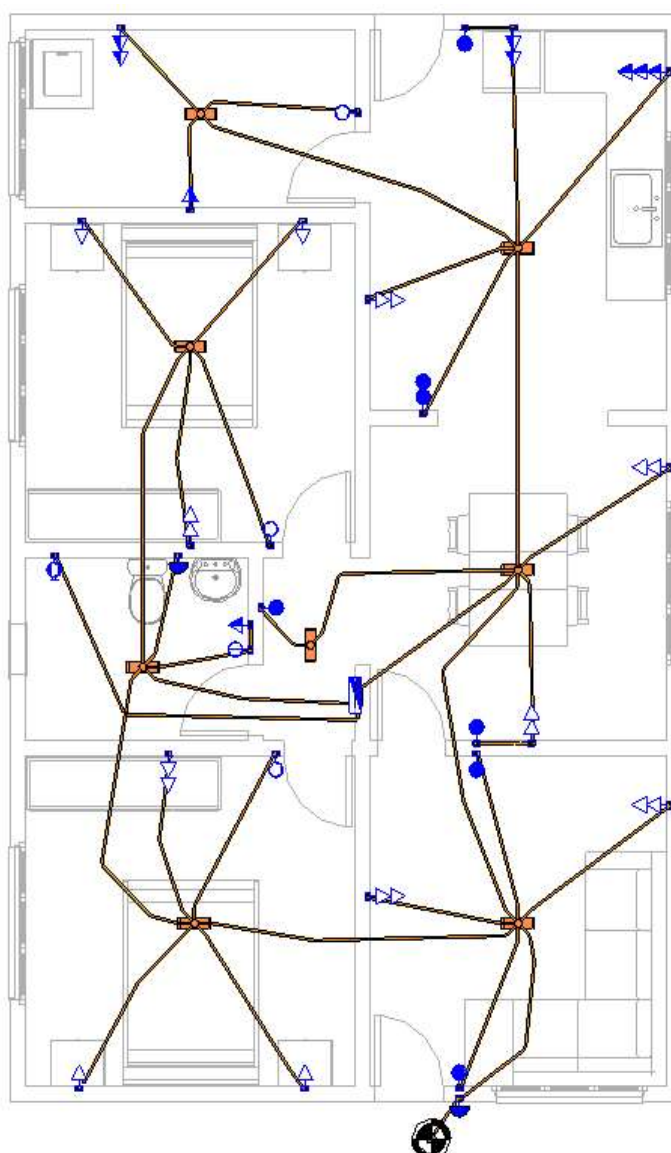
Planta Baixa com Pontos Alocados no Revit
